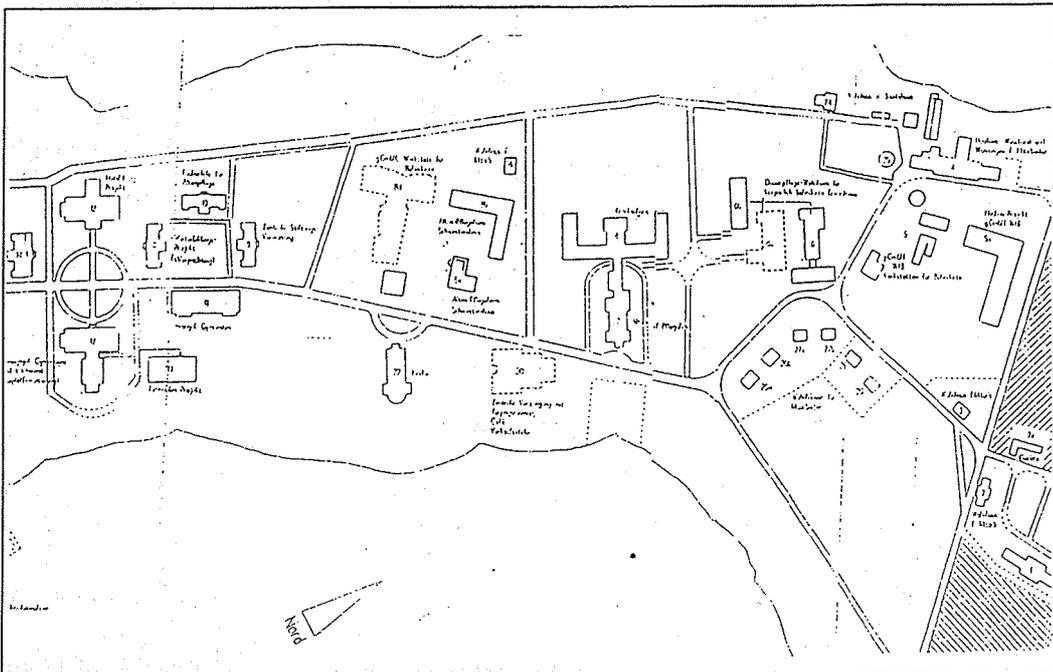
Lageplan mit den Gebäuden der Hoffbauer-Stiftung auf Hermannswerder
